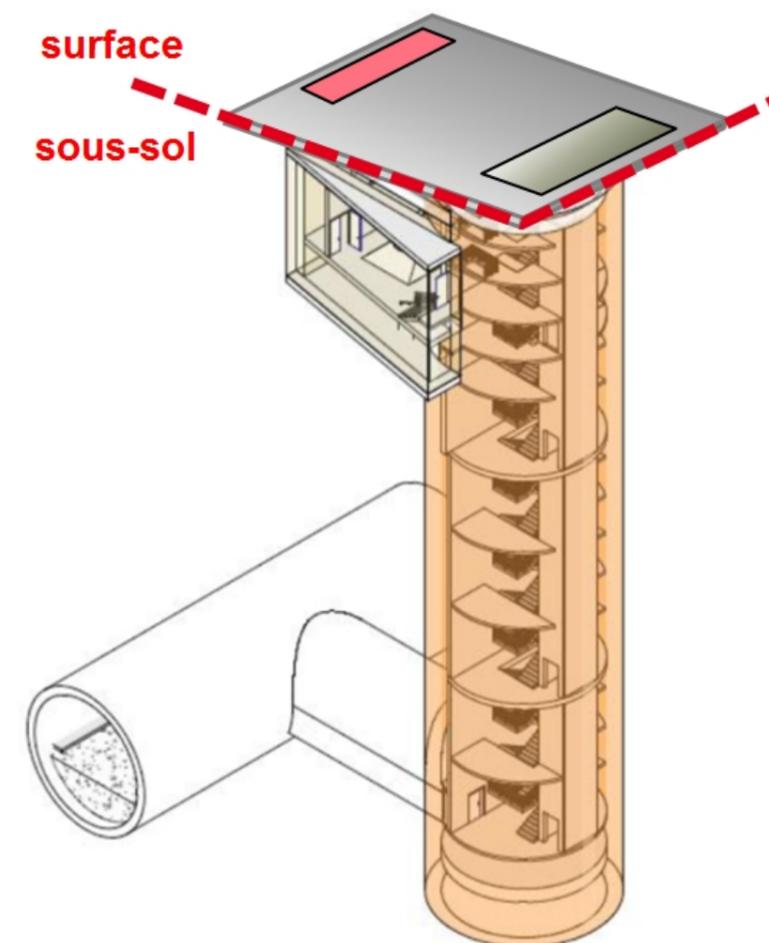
Exemple d'ouvrage relié au tunnel par un rameau (Source : Société du Grand Paris)
